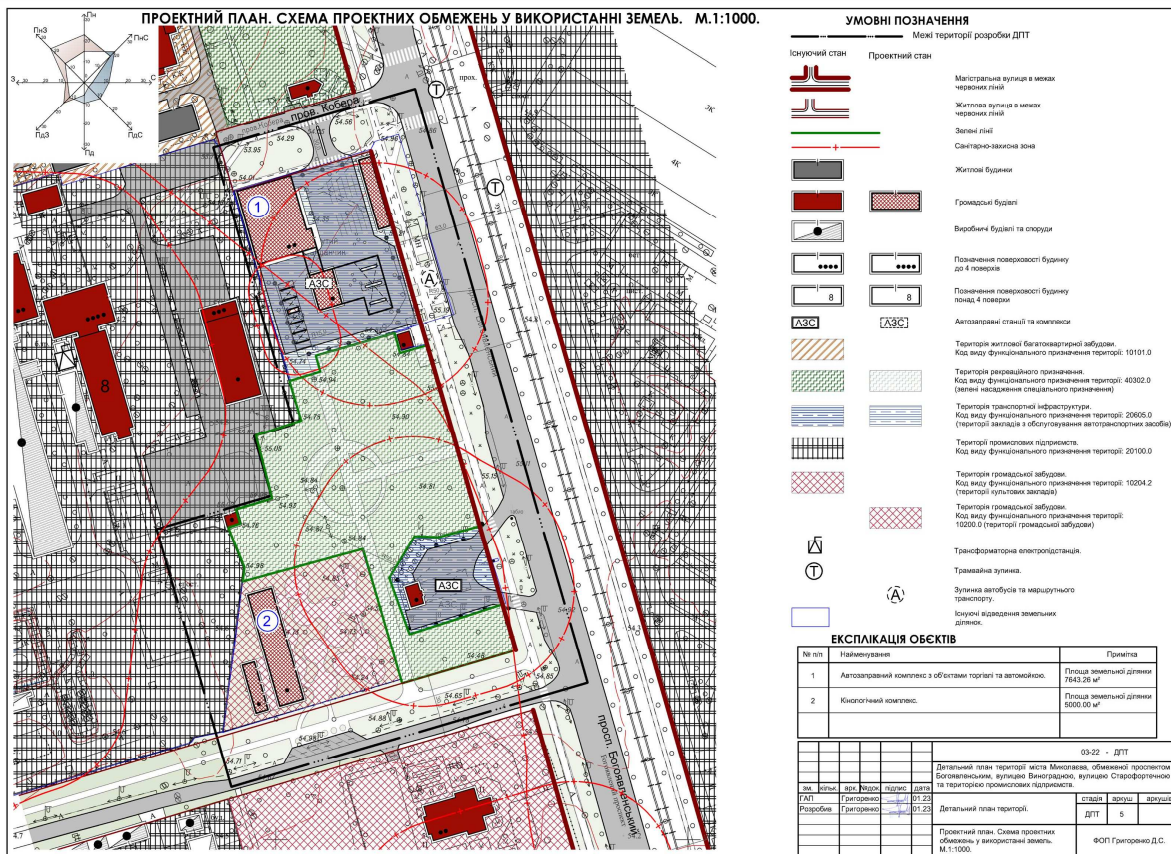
Проектний план поєднаний зі схемою проектних планувальних обмежень
